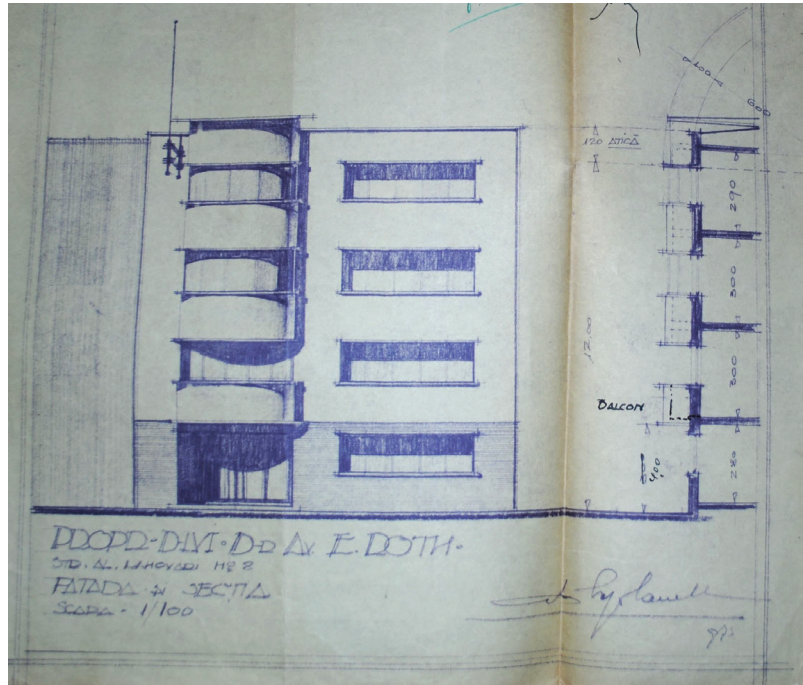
Archivzeichnung von Haus Dr. Roth, Fassade.
